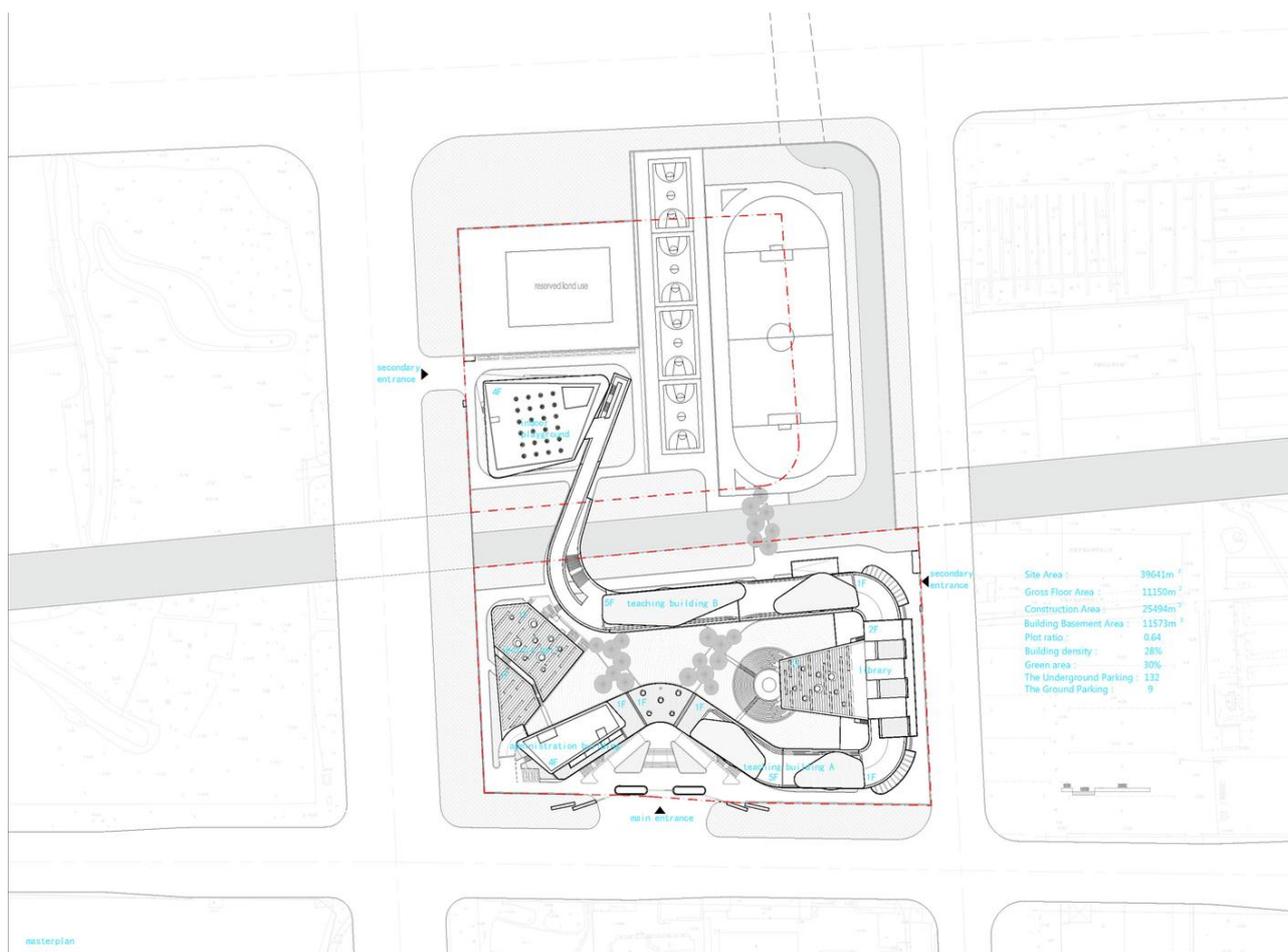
Генеральный план школы Liuyan в г. Уси, Китай
